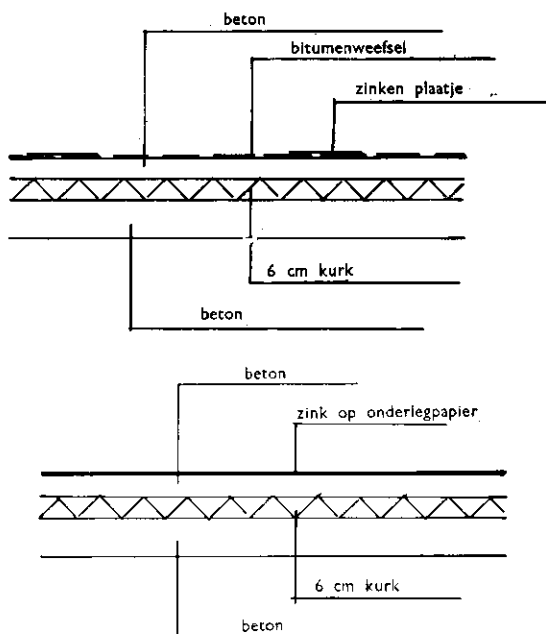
Enkele constructiemogelijkheden voor geïsoleerde vloeren.
